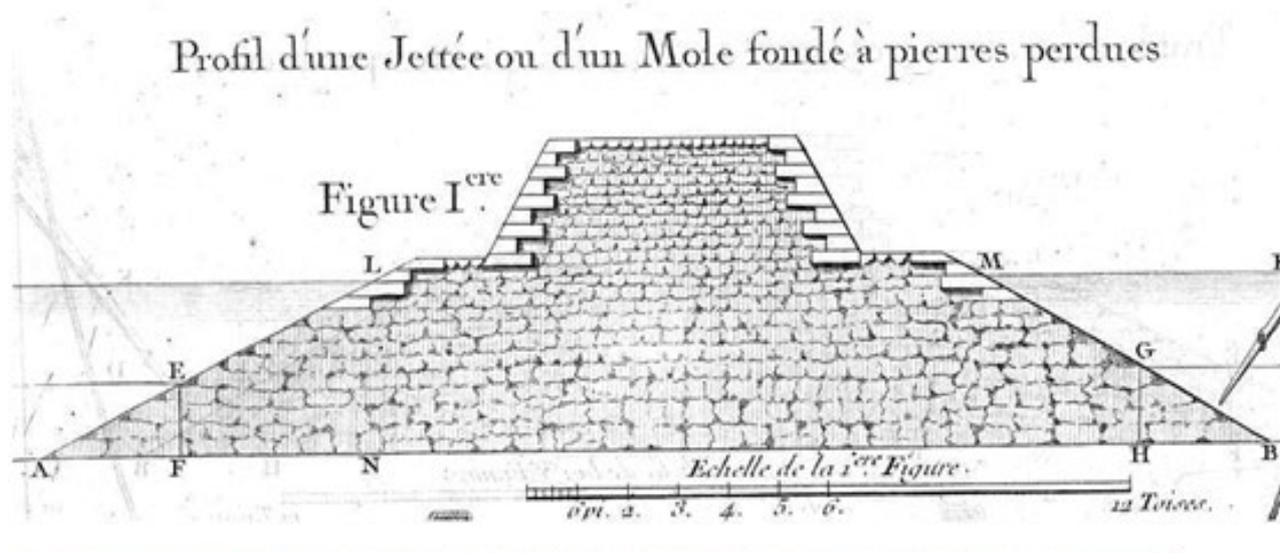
Fondation sur enrochement (extrait d'Architecture hydraulique de Belidor de 1737)
